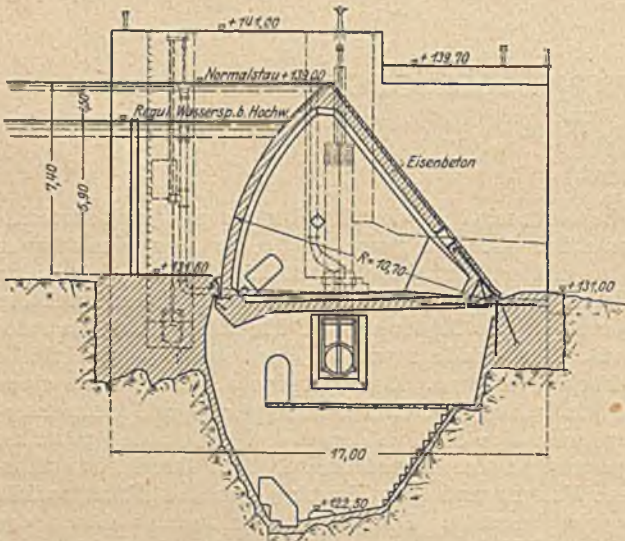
Schnitt durch das Eisenbetonsektorwehr der Brazilian Hydro-Electric Co. Ltd., Rio de Janeiro, Brasilien (Ausführung Stauwerke A. G.)
